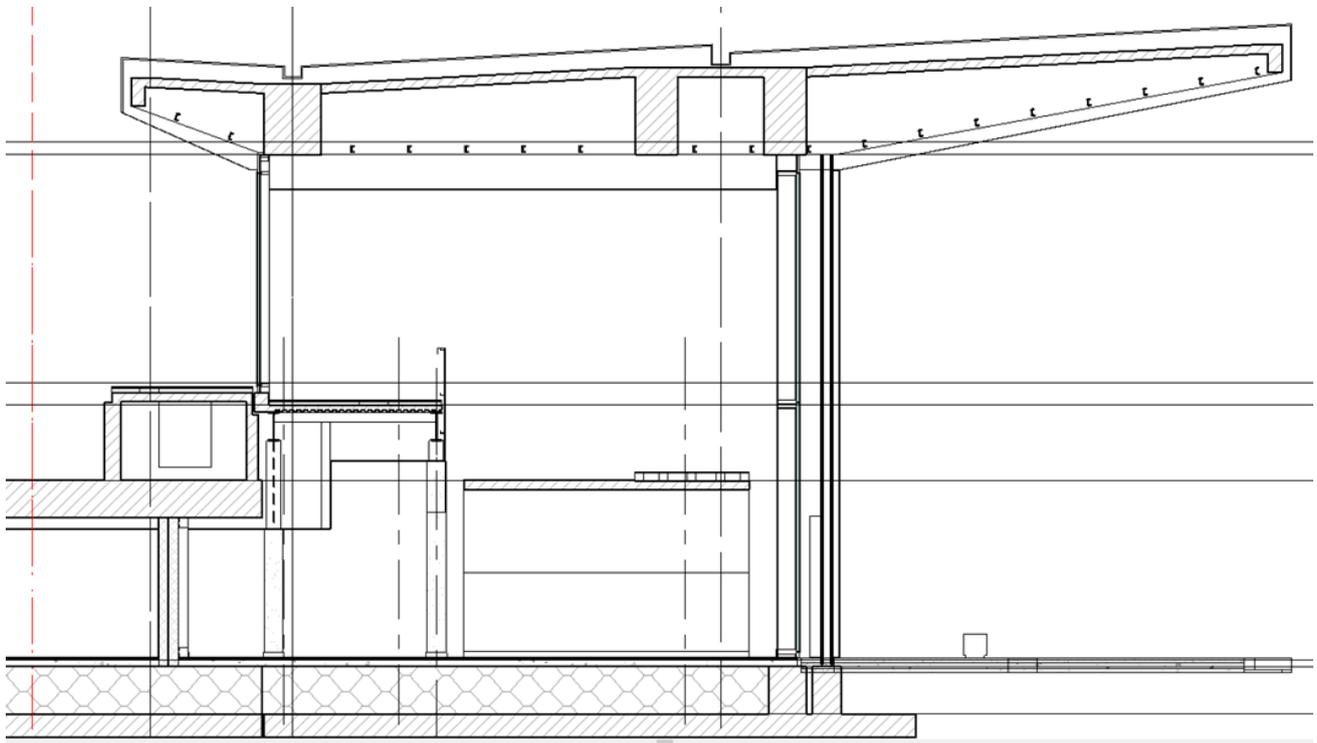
Sezione trasversale del fabbricato viaggiatori
